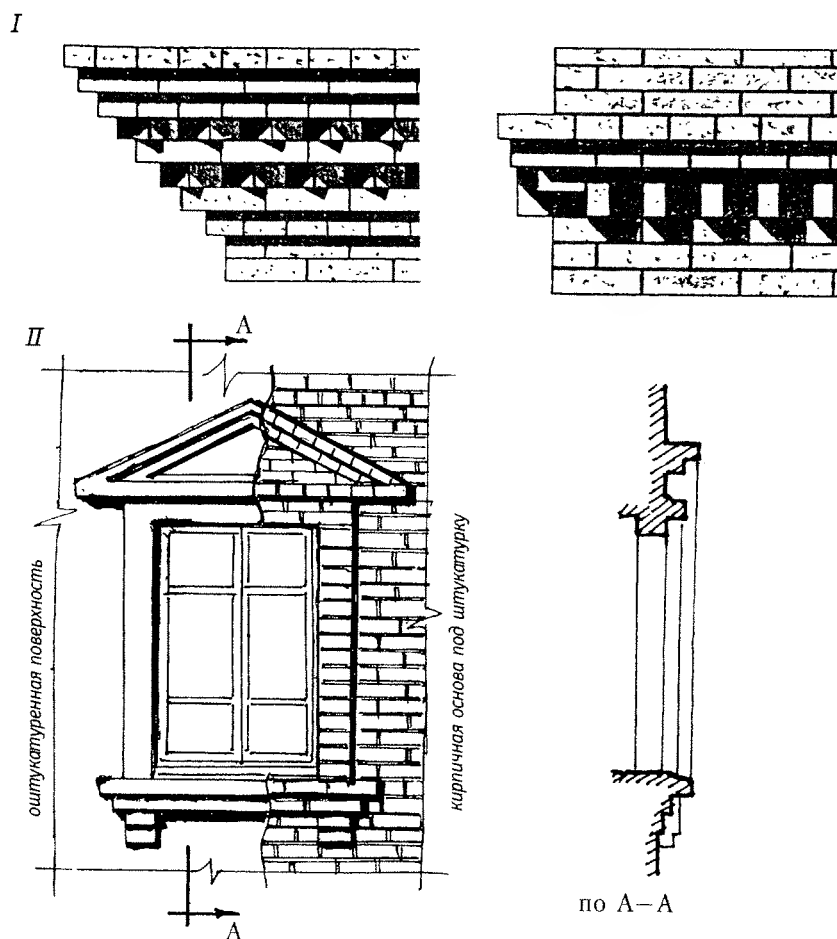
Варианты отделки фасадов с кирпичными стенами:
